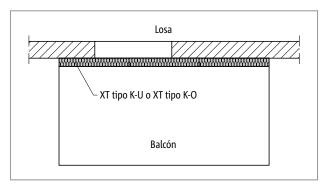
Schöck Isokorb® XT tipo K-U/ K-O: Balcón en voladizo
